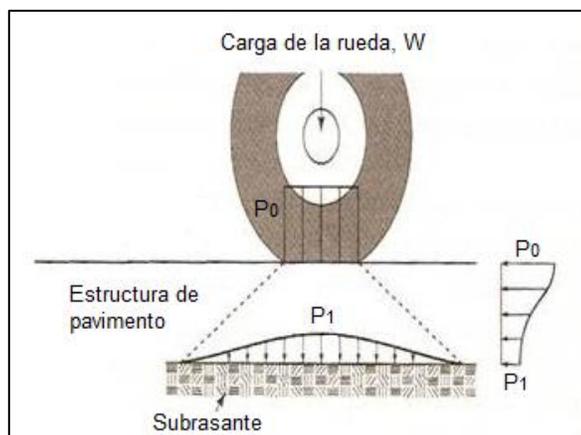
Distribución de esfuerzos en pavimentos flexibles.
